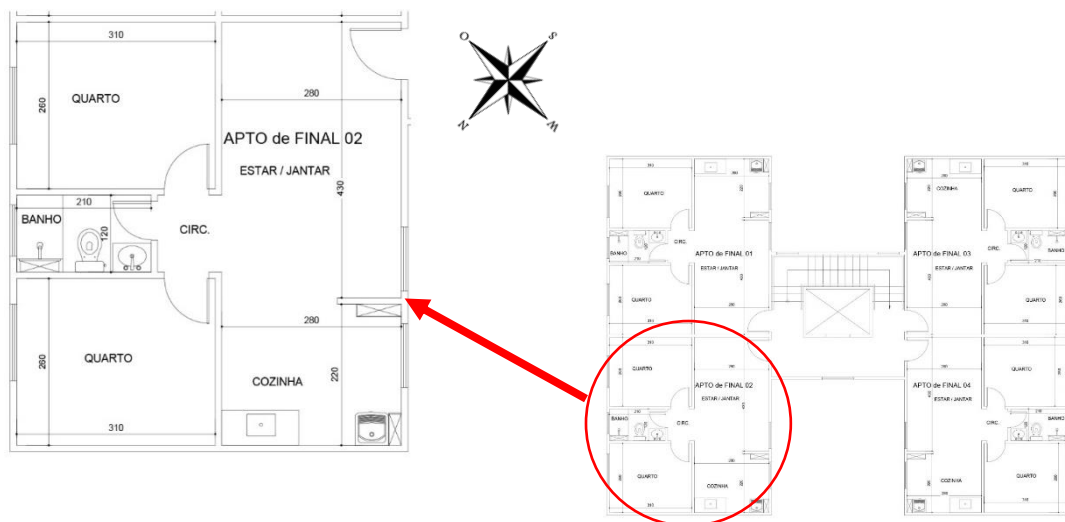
PLANTA APARTAMENTO TIPO
